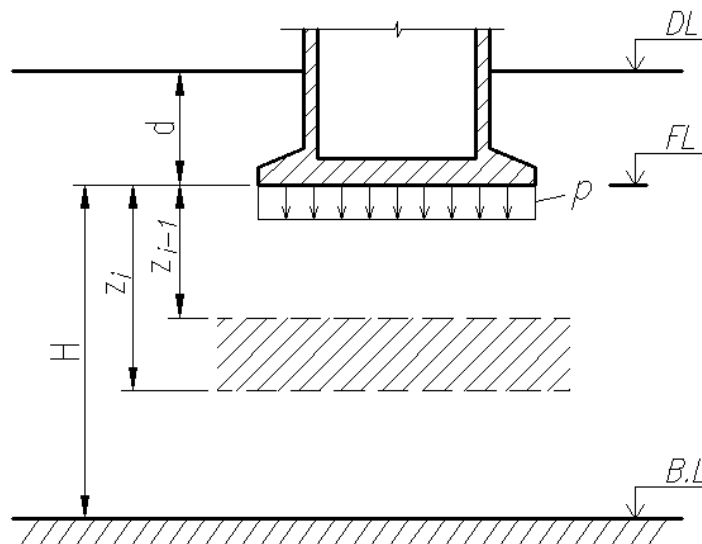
Схема к расчету осадки фундамента методом линейно-деформируемого слоя
